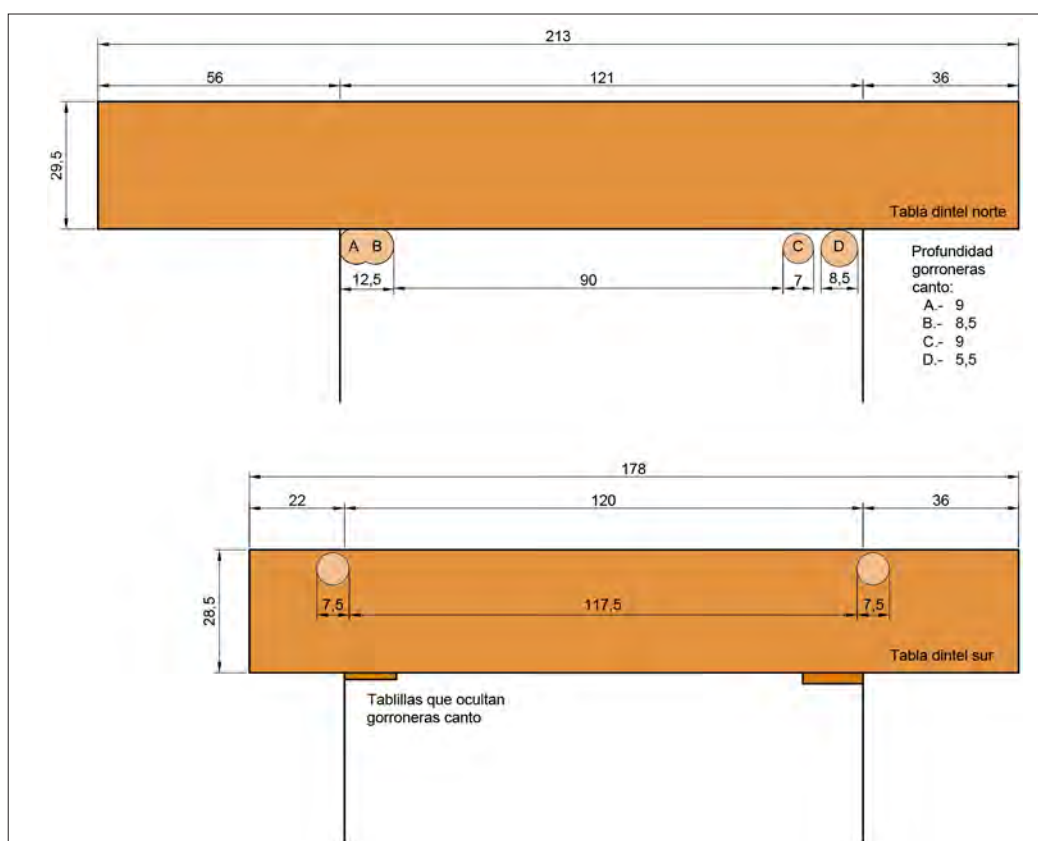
(anexo). Dimensiones de los descargaderos de madera de la puerta de acceso a la habitación norte y sur detallando la posición de las gorroneiras
